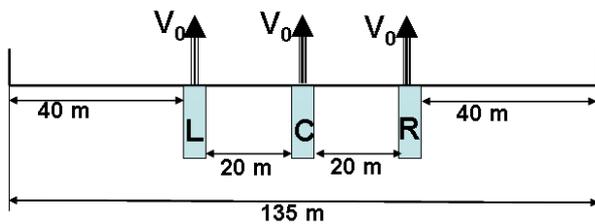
Схема размещения на отметке "-660 м" вентиляционных восстающих:
